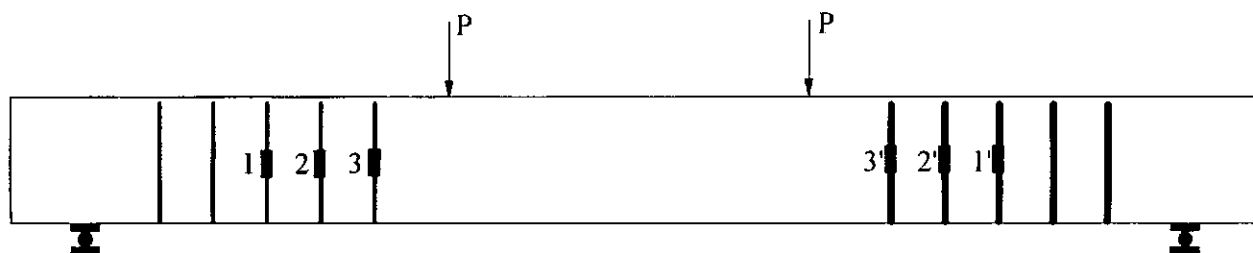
Posição dos extensômetros elétricos nas chapas das vigas V2 e V5
